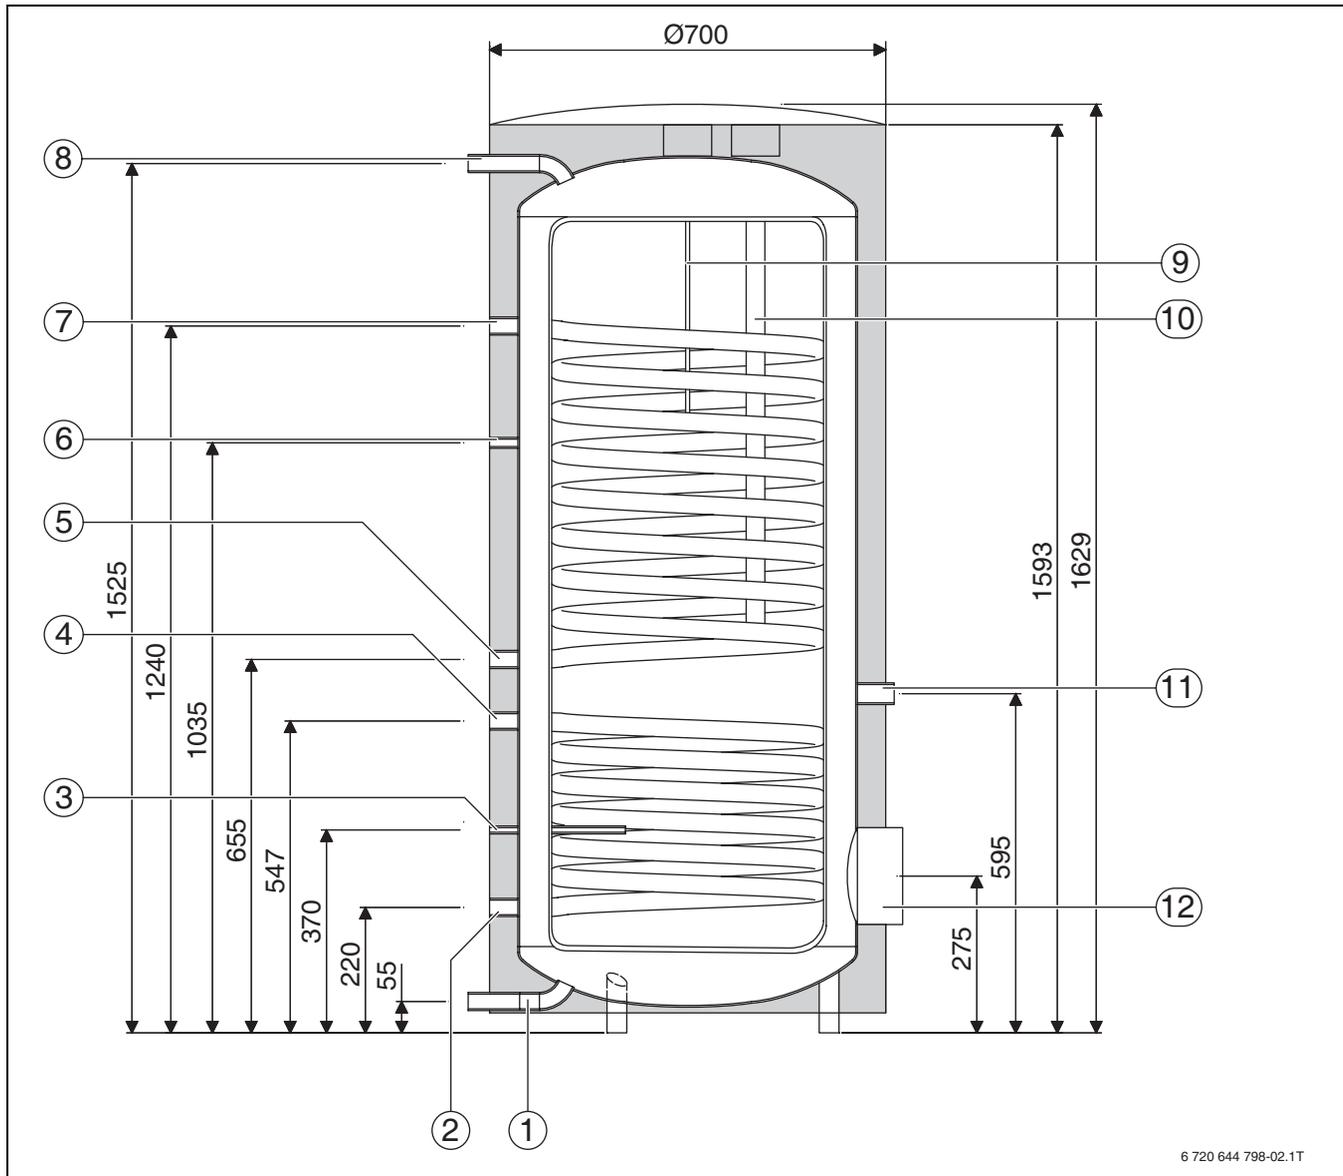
Abmessungen und Anschlüsse für Logalux SH 300 EW, SH 380 EW und SH 440 EW (alle Maße in mm)
